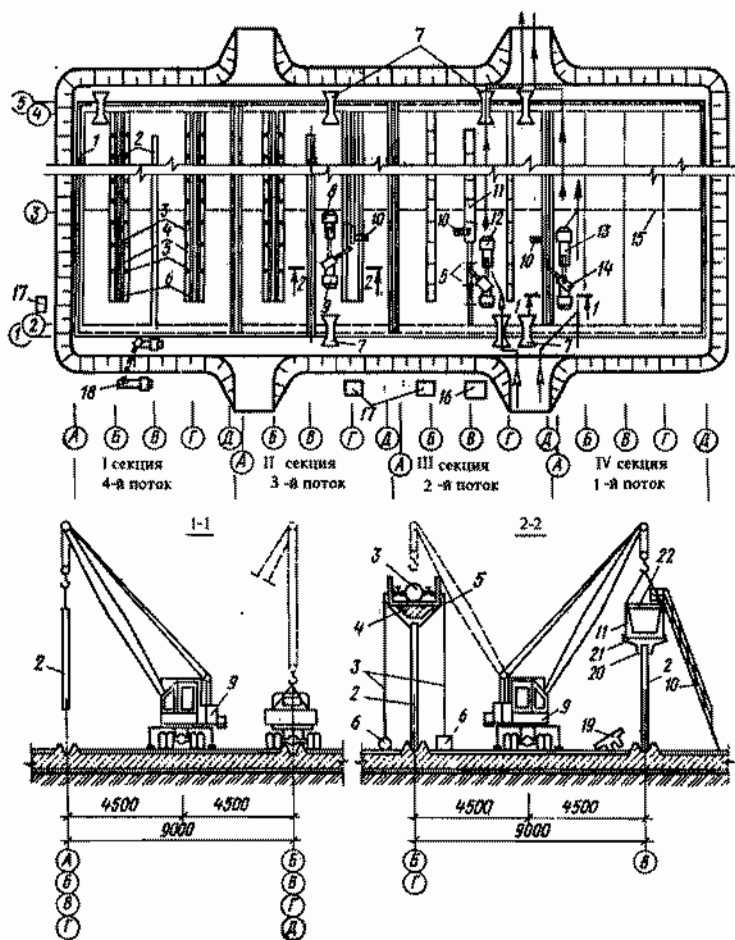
Схема монтажа четырехкоридорных аэротенток из типовых плоских панелей раздельным методом: 1 - стеновые панели наружные; 2 - то же, внутренние; 3 - воздухопроводы с отводами к фильтросным каналам; 4 - плиты ходовых мостиков; 5 - балки; 6 - фильтросные каналы; 7 - инвентарные переездные мостики; 8 - бортовой автомобиль; 9 - автокран; 10 - стремянки; 11 - лотки; 12 - автомобиль по доставке лотков; 13 - панелевоз; 14 - пневмоколесный кран, устанавливающий стеновые панели; 15 - температурно-усадочный шов; 16 - растворонасос для замоноличивания стыков; 17 - электросварочные агрегаты; 18 - панелевоз по доставке панелей для торцевых стен; 19 - балка, подготовленная к установке; 20 - клинья для временно-го крепления балок; 21 - сварной шов; 22 - предохранительная распорка в лотке
